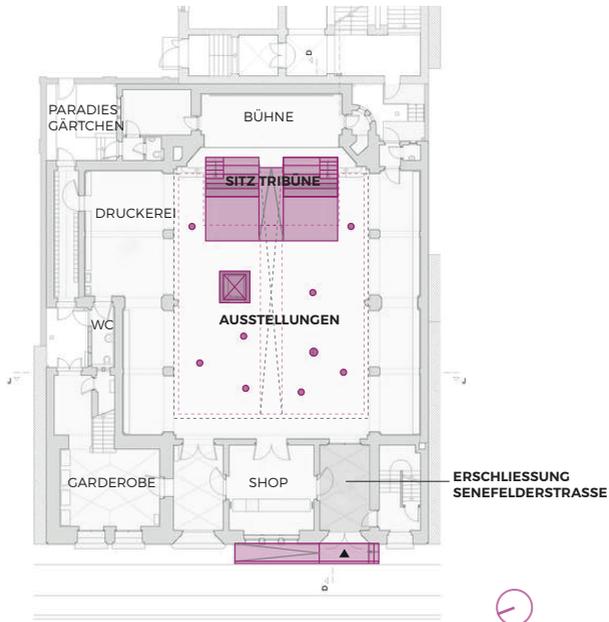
Grundriss Gesamt EG 1:500
